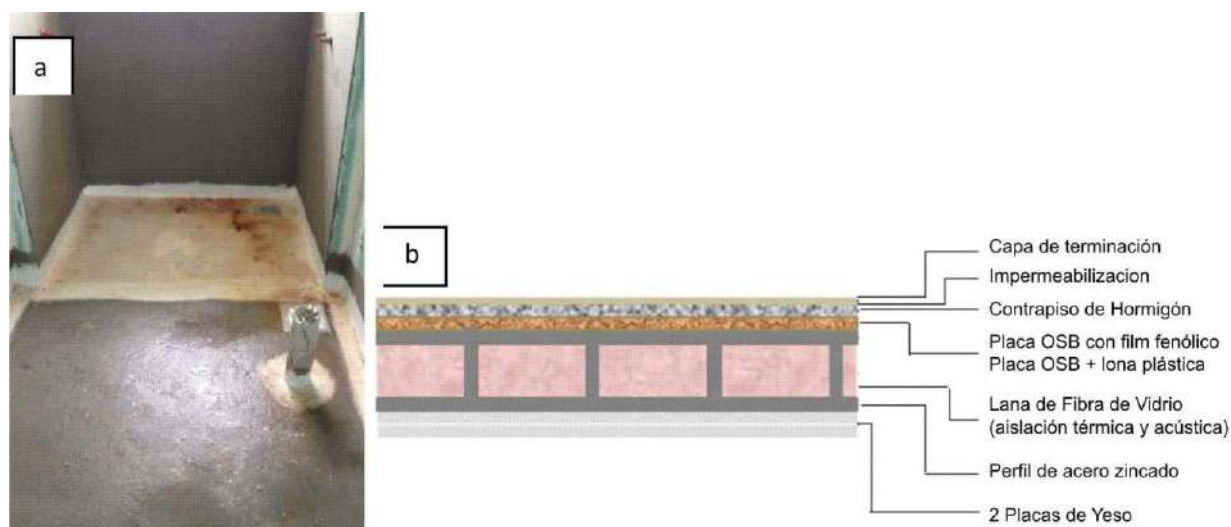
(a) detalle de impermeabilización; (b) configuración del sistema de entrepiso compuesto por perfiles de acero zincado, placa OSB con revestimiento fenólico, contrapiso y revestimiento de piso
